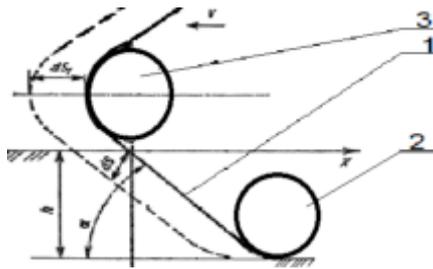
Схема уплотнения грунта обечайкой в форме горизонтального эллипса
